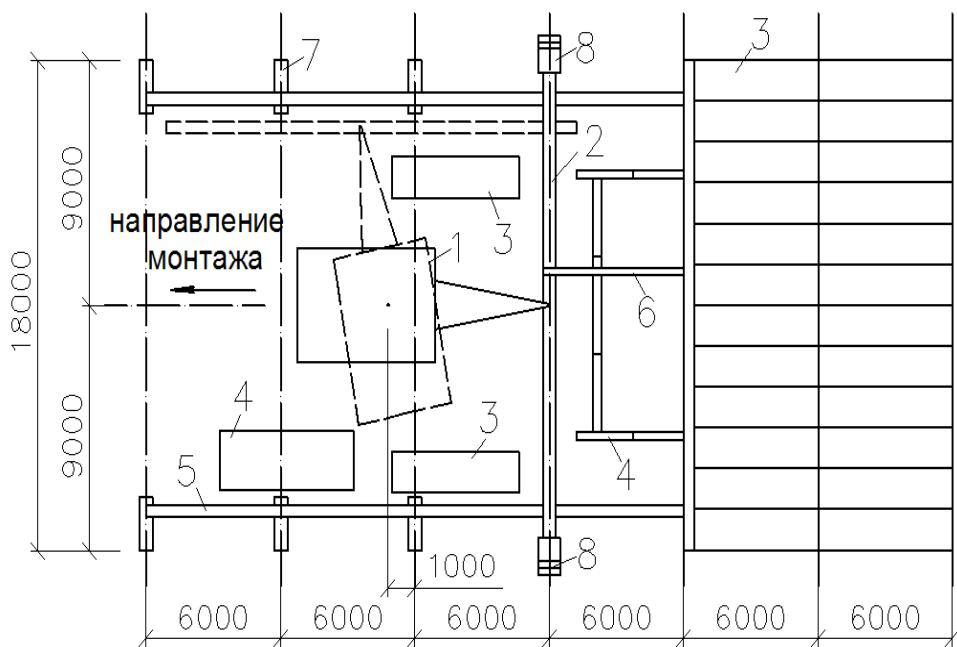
Схема монтажа здания фильтров водоочистной станции: 1 – кран; 2 – стропильная ферма; 3 – плиты покрытия; 4 – стеновые панели фильтра; 5 – подкрановая балка; 6 – распорка; 7 – колонна; 8 – лестницы приставные с площадками
